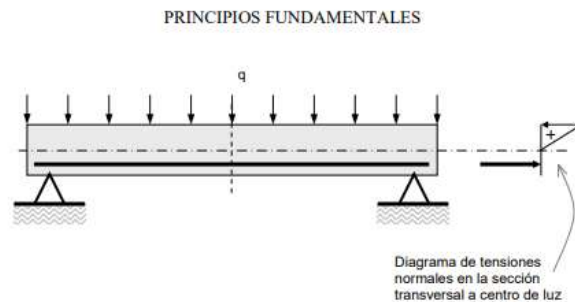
Viga de hormigón con acero en la zona de tracción.
